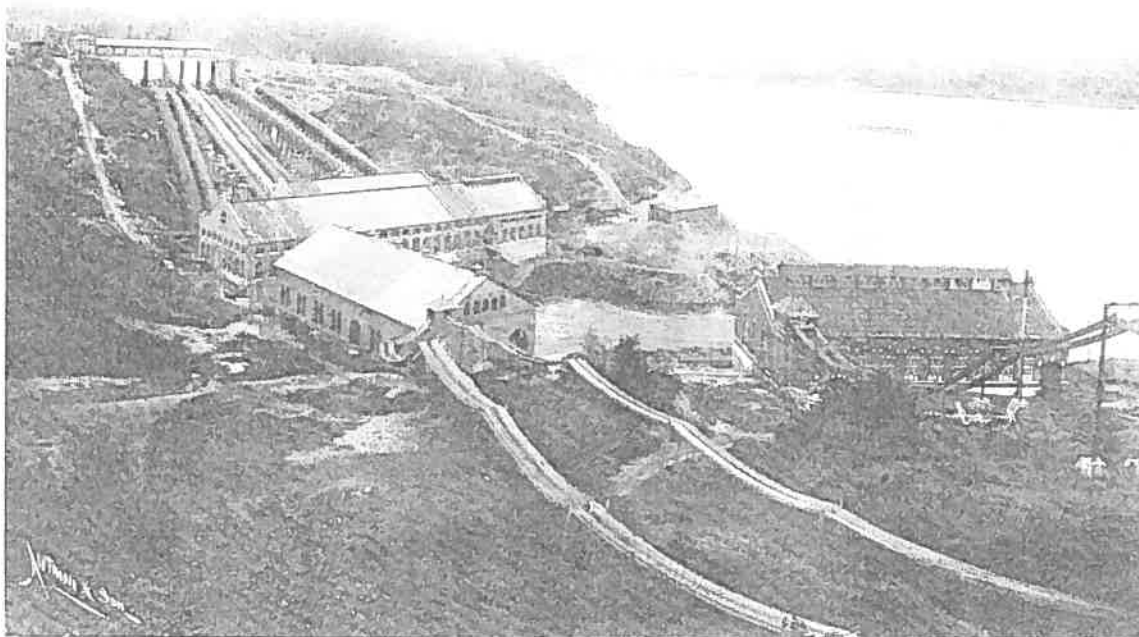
Les premières installations hydroélectriques construites au début du XXe siècle
